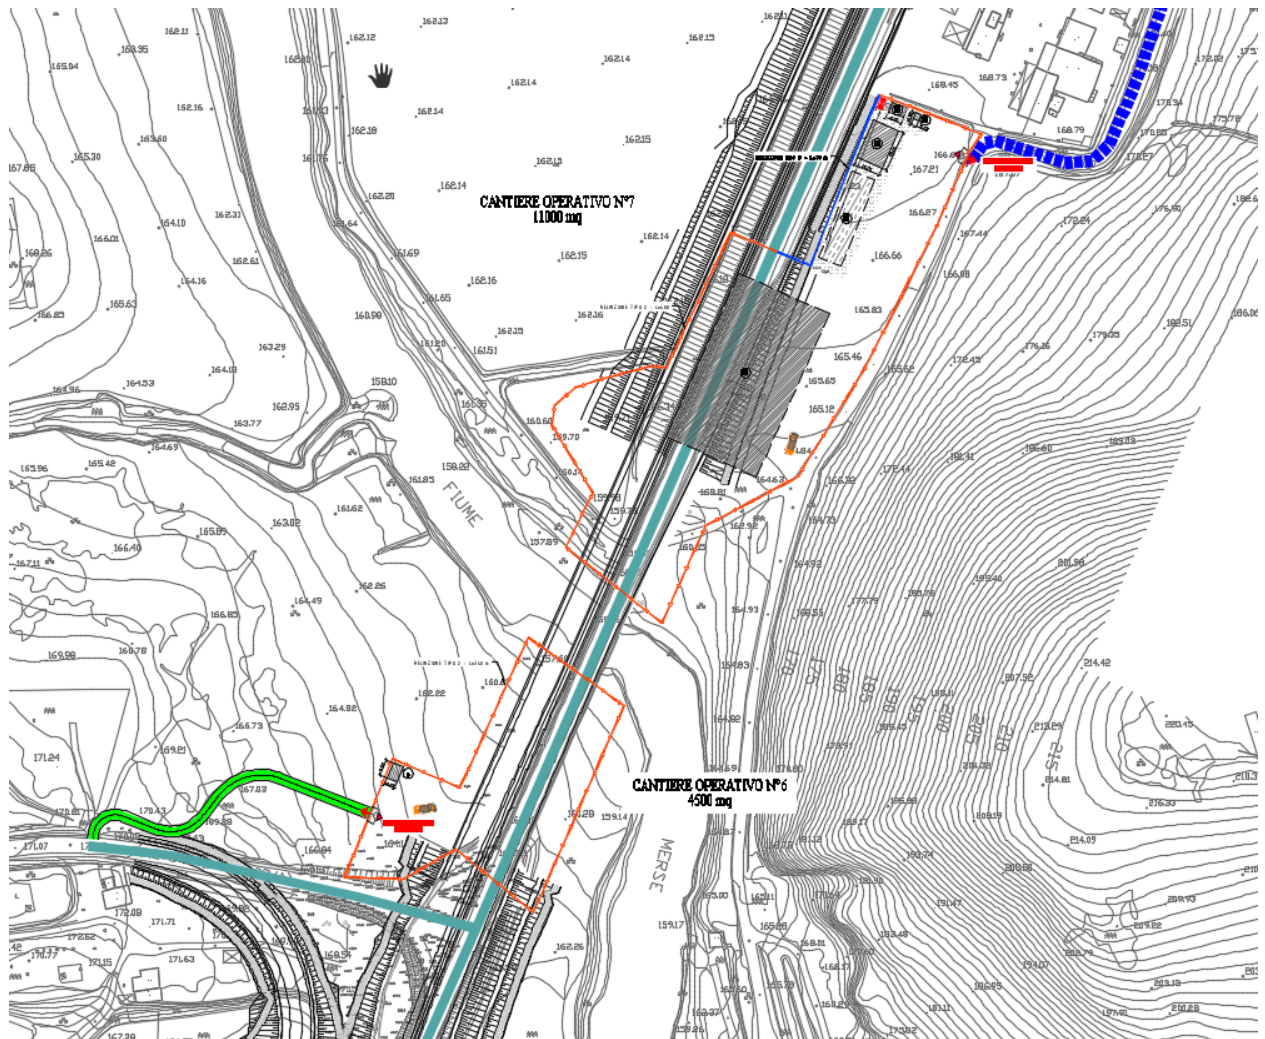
Planimetria cantiere operativo 6 e cantiere operativo 7.
